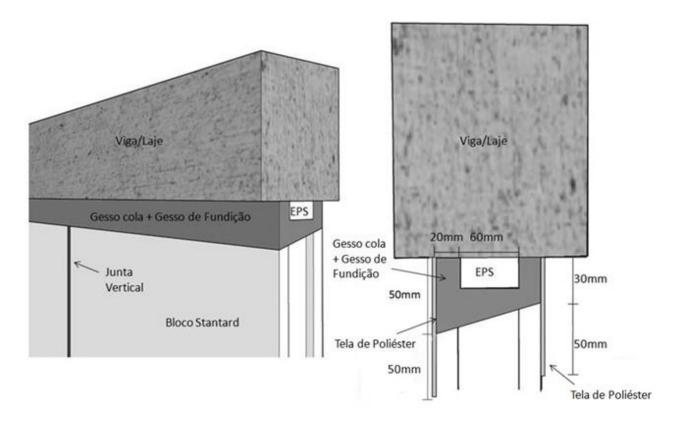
Ligação entre blocos de gesso e viga ou laje maciça
